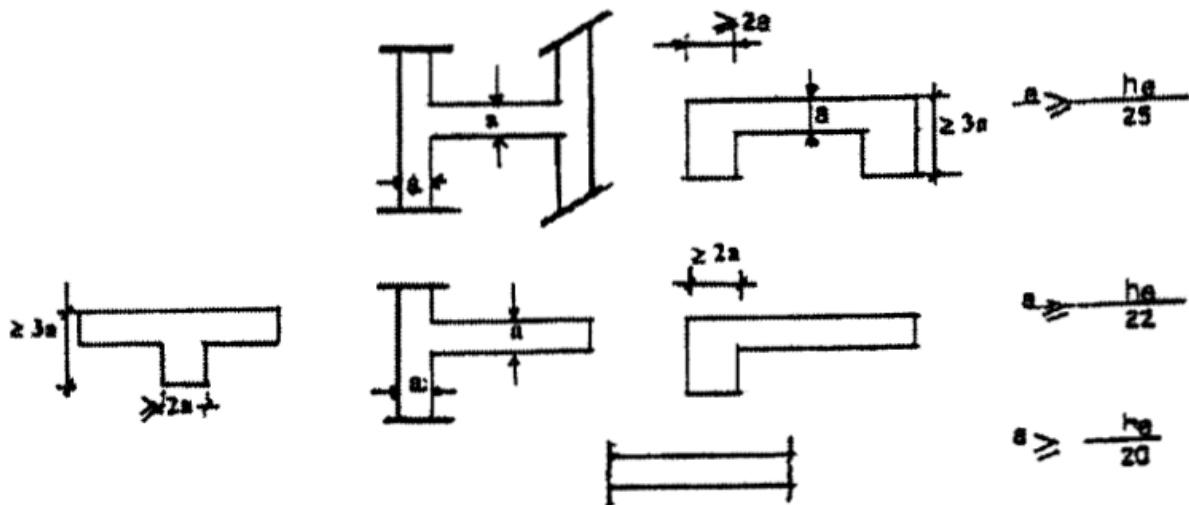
Coupe de voile en plan selon RPA 2003
